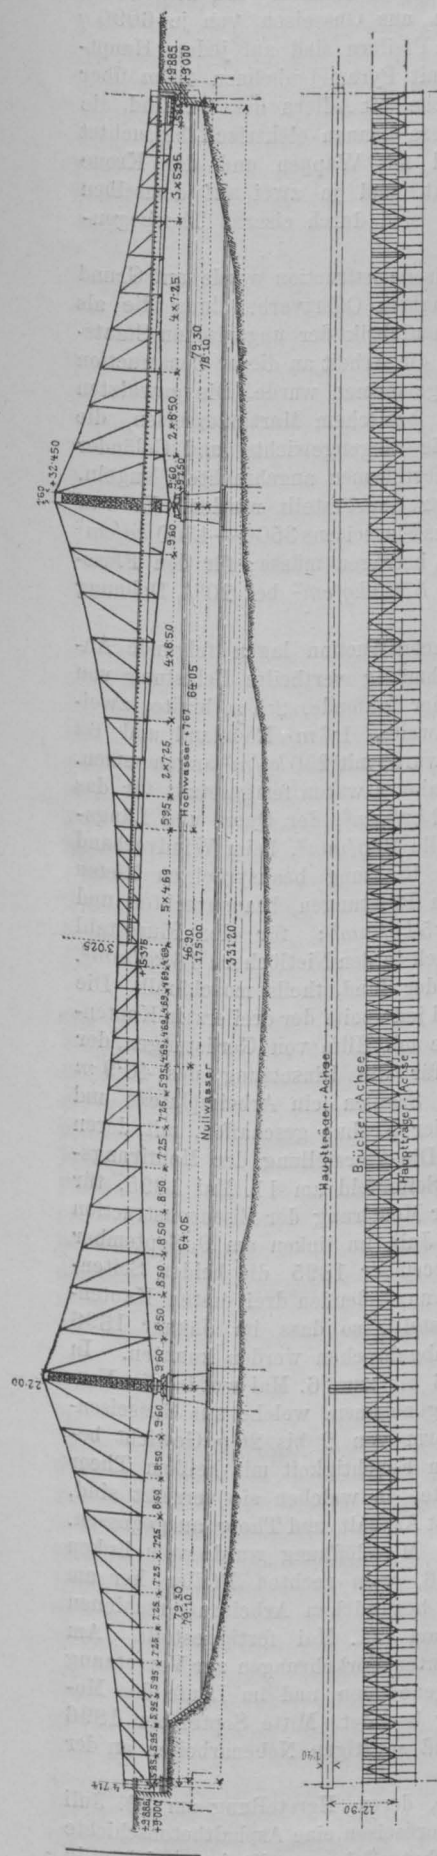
, Längenschnitt, — Schnitt und Grundriss, 1:1500.
